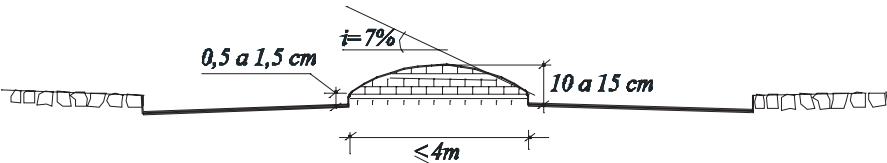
Perfil transversal de uma Mini-rotunda - pormenor da ilha central
